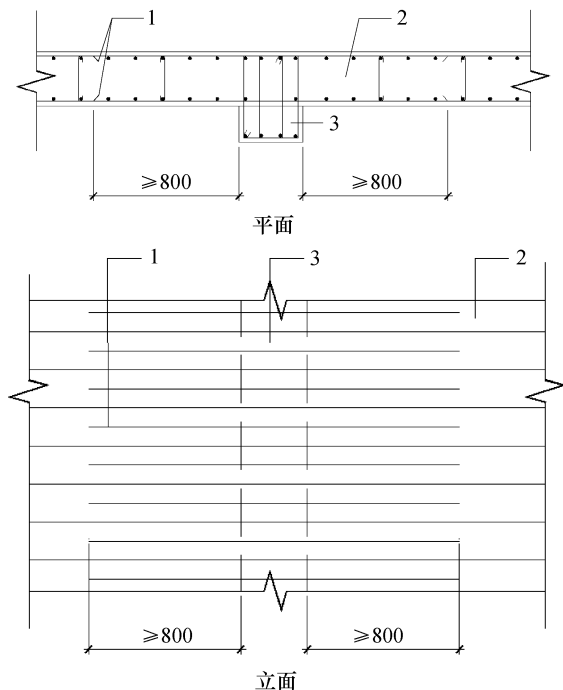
地下室结构外墙板扶壁柱两侧附加钢筋
